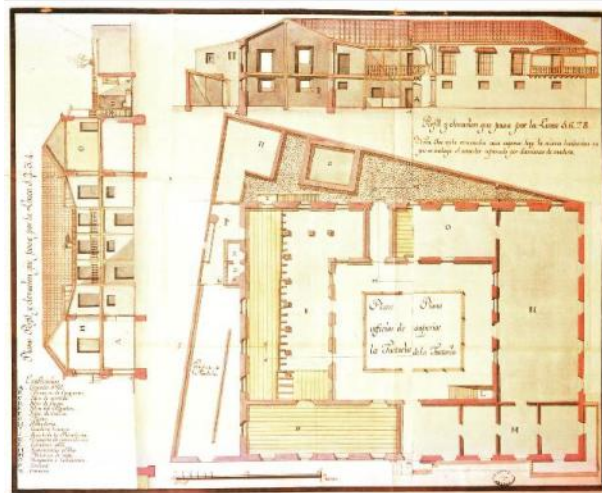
Planta y alzados de las instalaciones de la Guipuzcoana en el puerto de Maracaibo (Vivas Pineda, 1998, p. 271).
